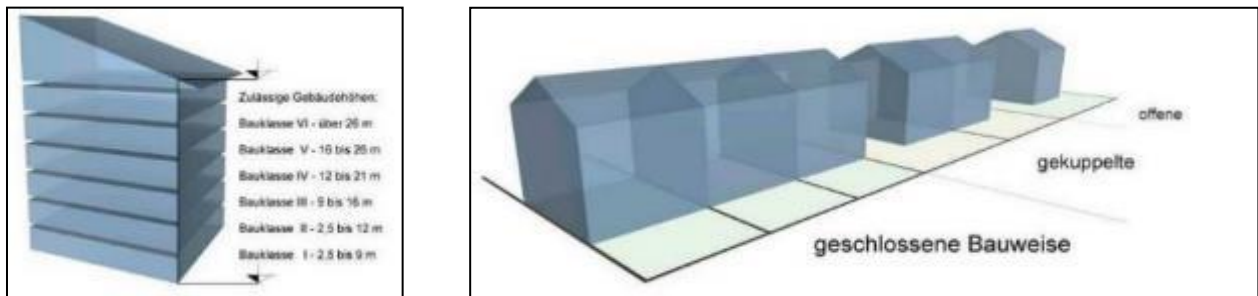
Bauklassen (links) und Bauweisen (rechts) nach Wiener Bauordnung
